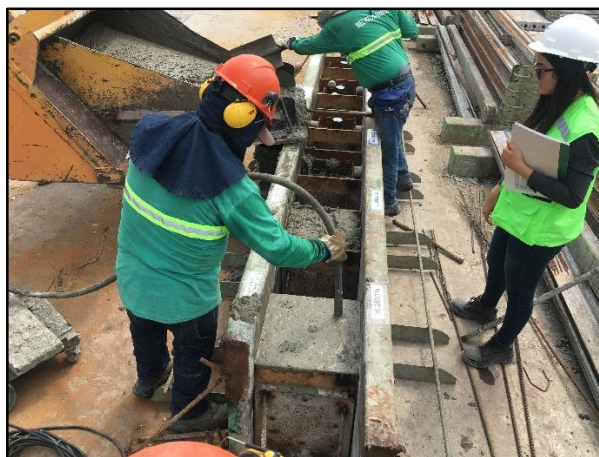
Hormigonado de bloques de ensayo. Fuente del autor.
